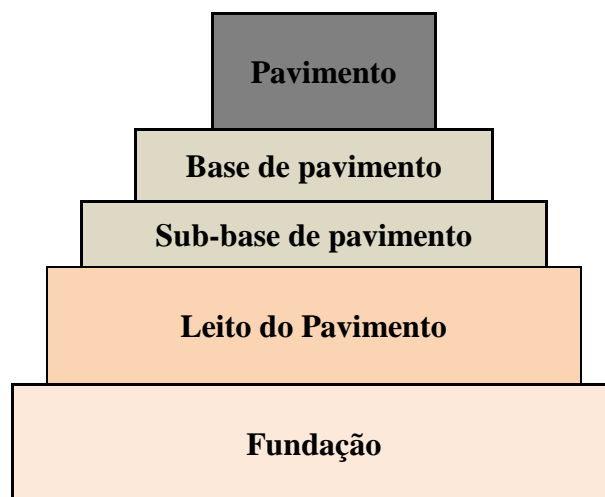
Estrutura genérica de pavimento tipo, em zona de escavação
